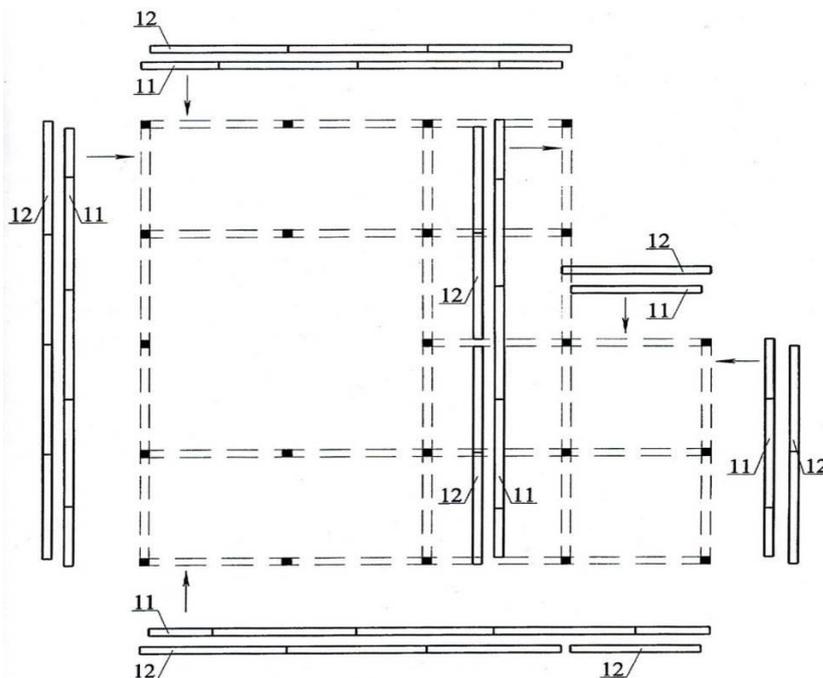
Общий план здания с маркировкой деревянных панелей
